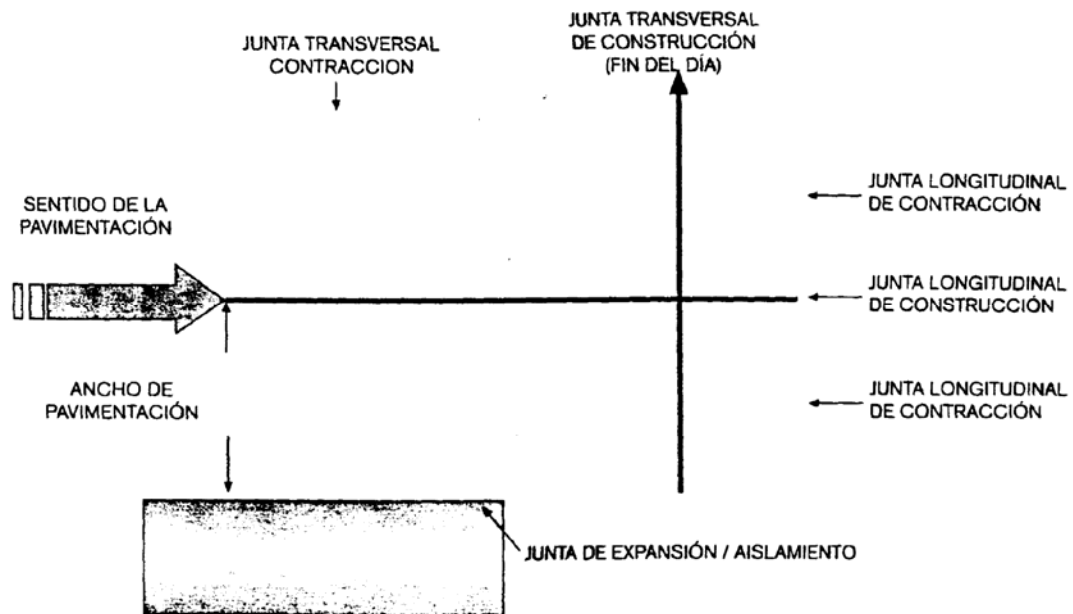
Croquis de los tipos de juntas en un pavimento de concreto.
